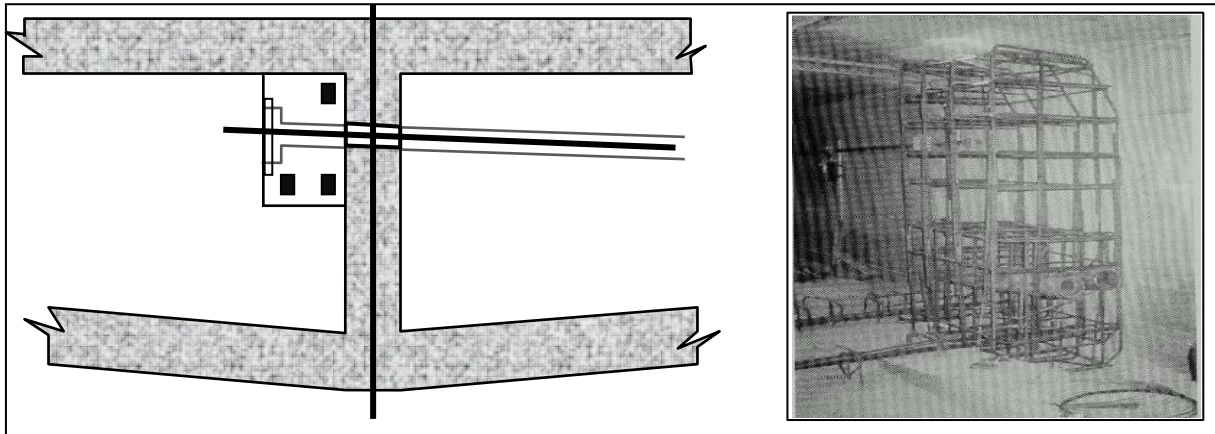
Appui sur entretoise renforcée Figure 2-26 : Ferrailage complémentaire
